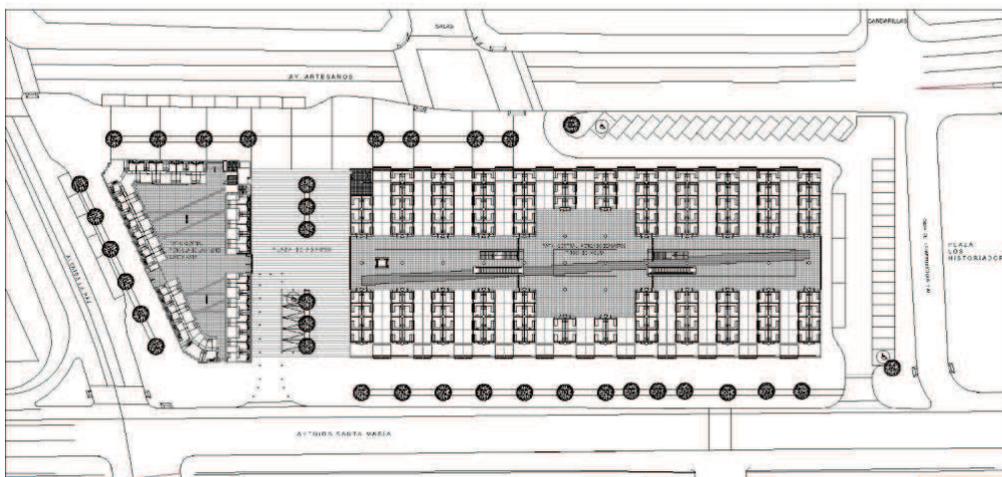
VISTA PLANTA DE CONJUNTO
